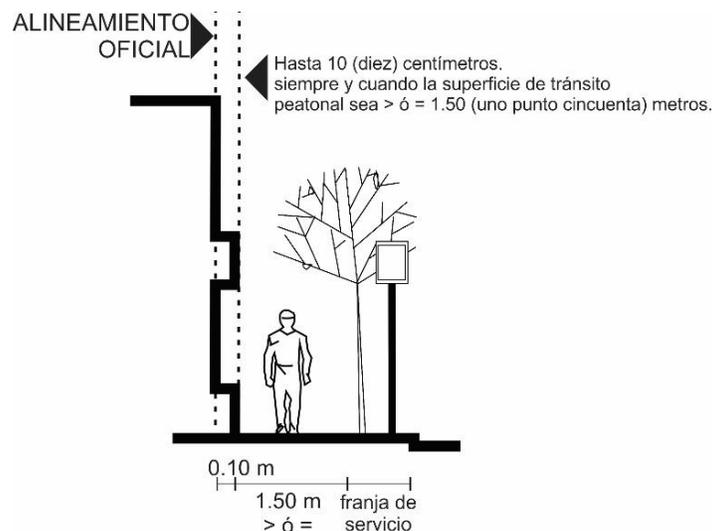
Proyección máxima de elementos en alto relieve de la fachada.
